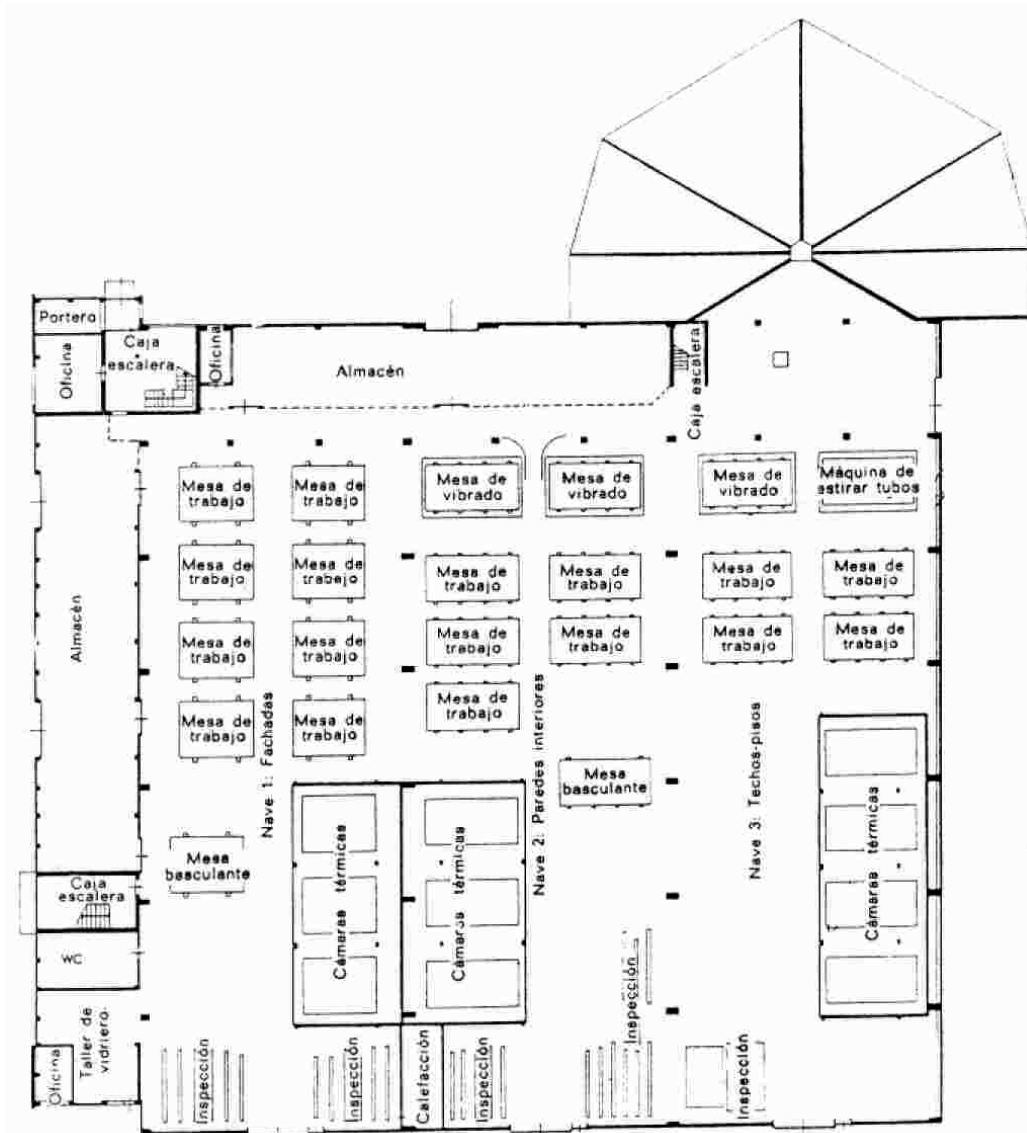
Planta de la fábrica de concreto de Trappenkamp Max Glese y Paul Hammers
